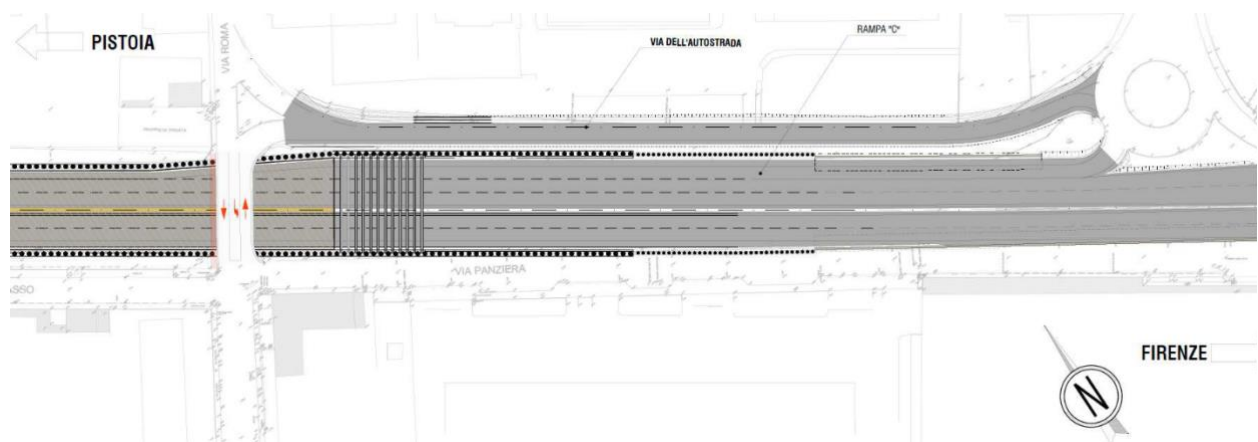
Stralcio planimetrico con individuazione della rampa C
